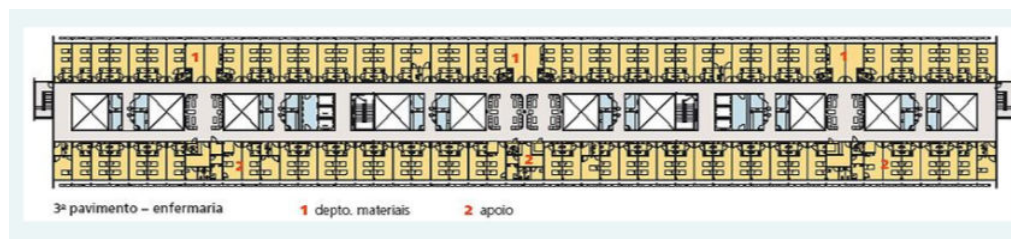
Planta baixa - pavimento tipo (FIGUEROLA, 2007).
